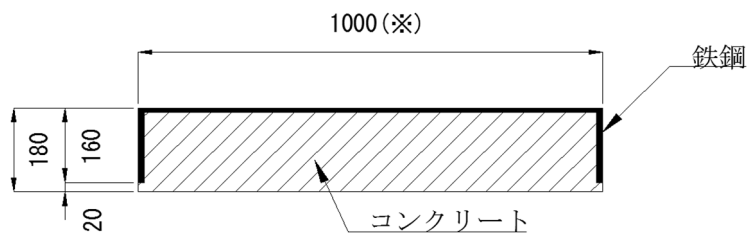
セグメント標準断面図（延長方向）（鉄筋コンクリート造）
